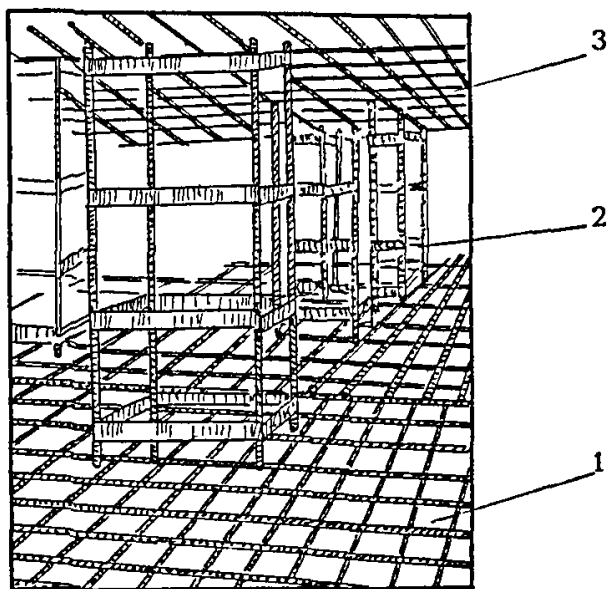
Армирование плиты по схеме: — нижняя арматурная сетка —
